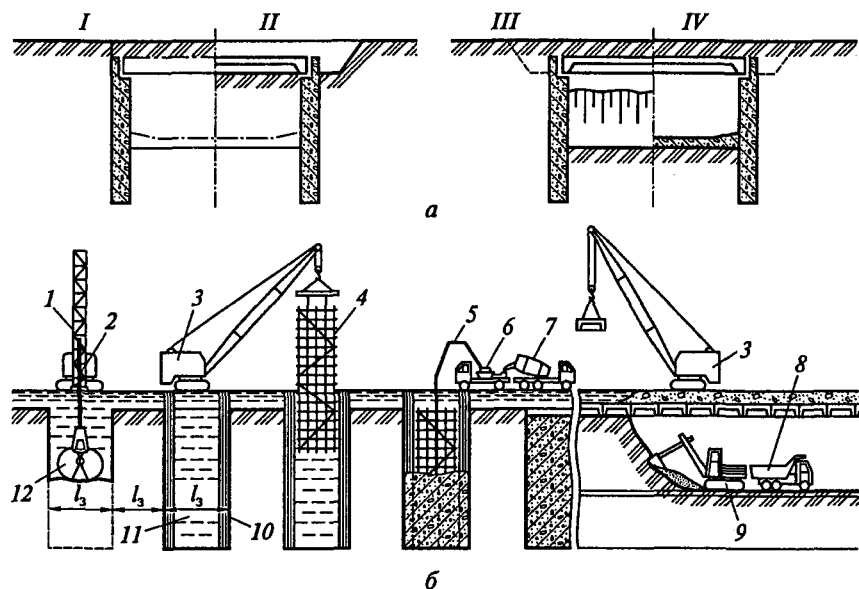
Этапы работ (а) и технологическая схема (б) сооружения тоннеля траншейным способом:
